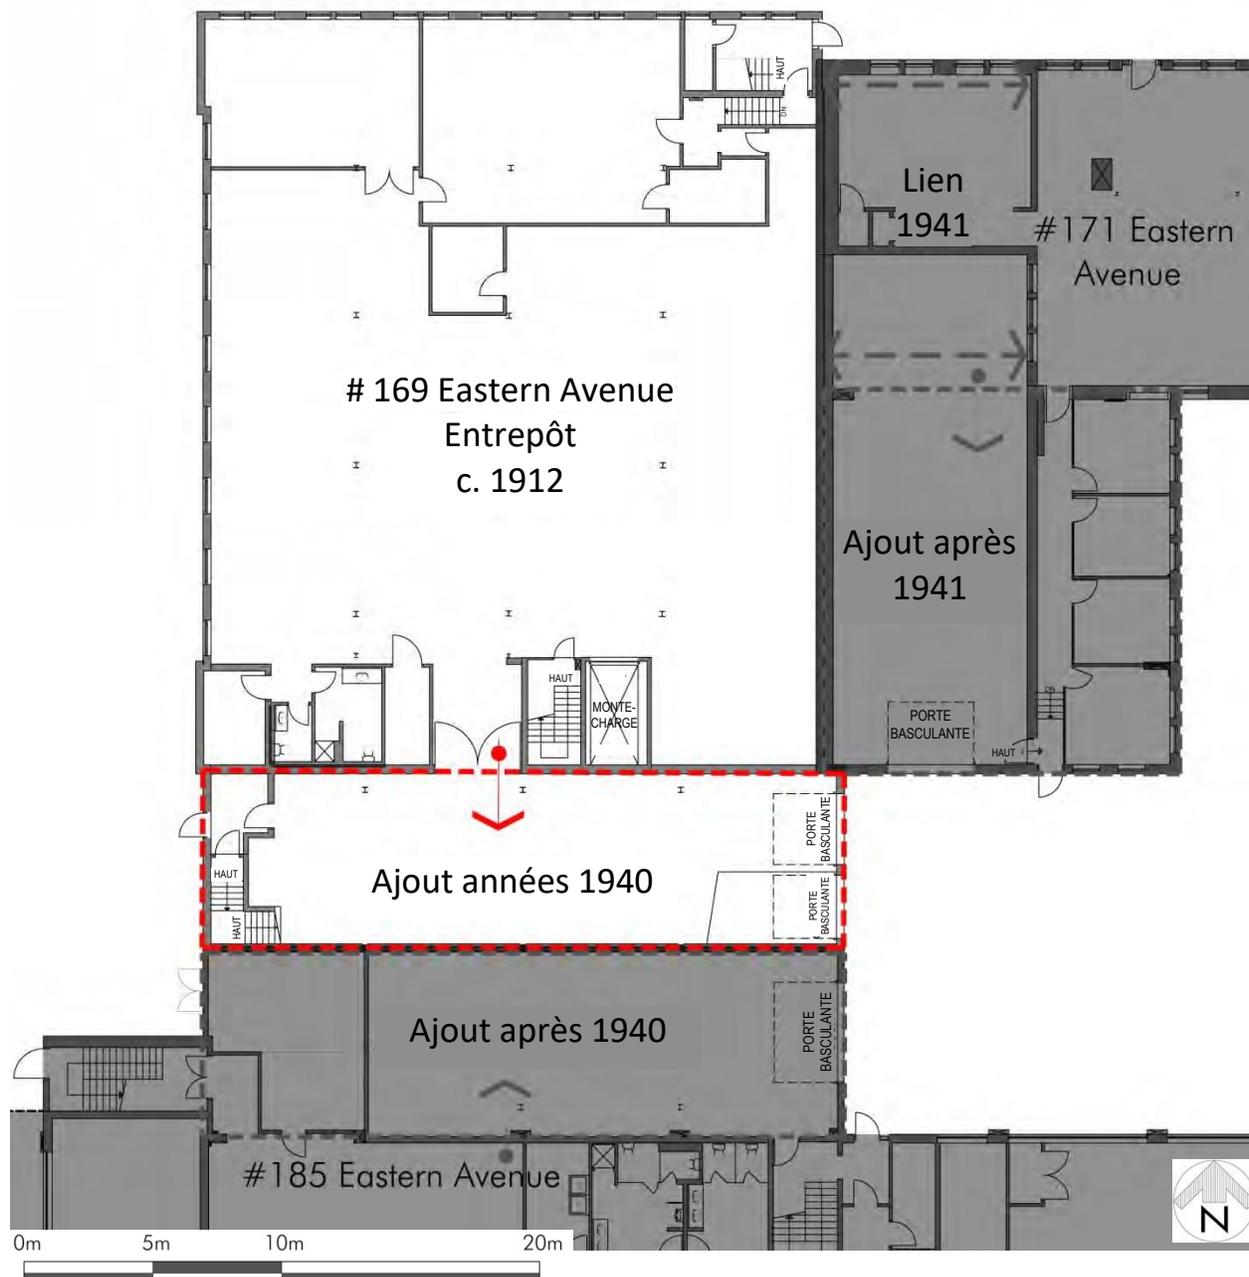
169 avenue Eastern – Plan du rez-de-chaussée de l'entrepôt.
